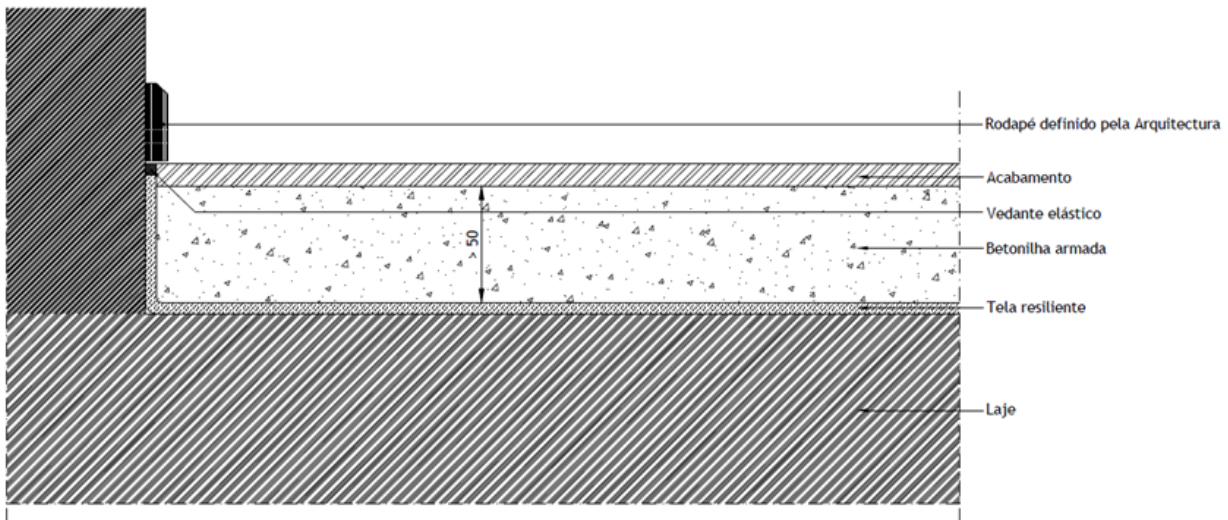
Pormenor construtivo do pavimento do bloco C da Escola Secundária de Gondomar [53].
